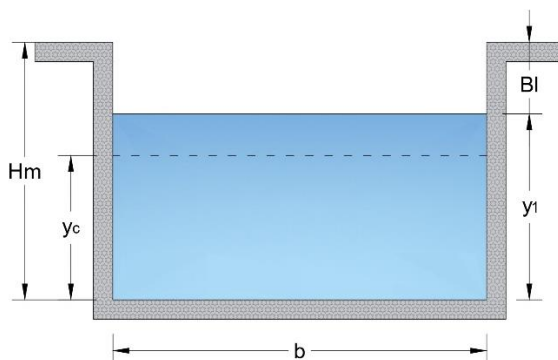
Sección transversal de un canal rectangular. Fuente: Elaboración propia.
